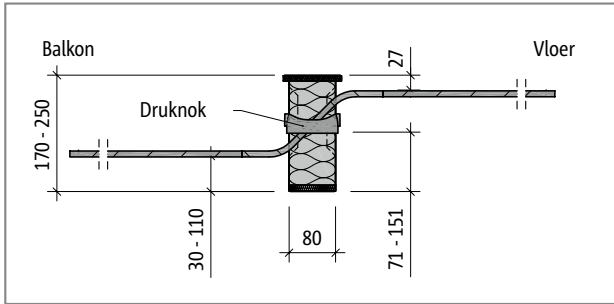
Schöck Isokorb® T type Q-E-Z-W-V1 tot V3: Zijaanzicht
